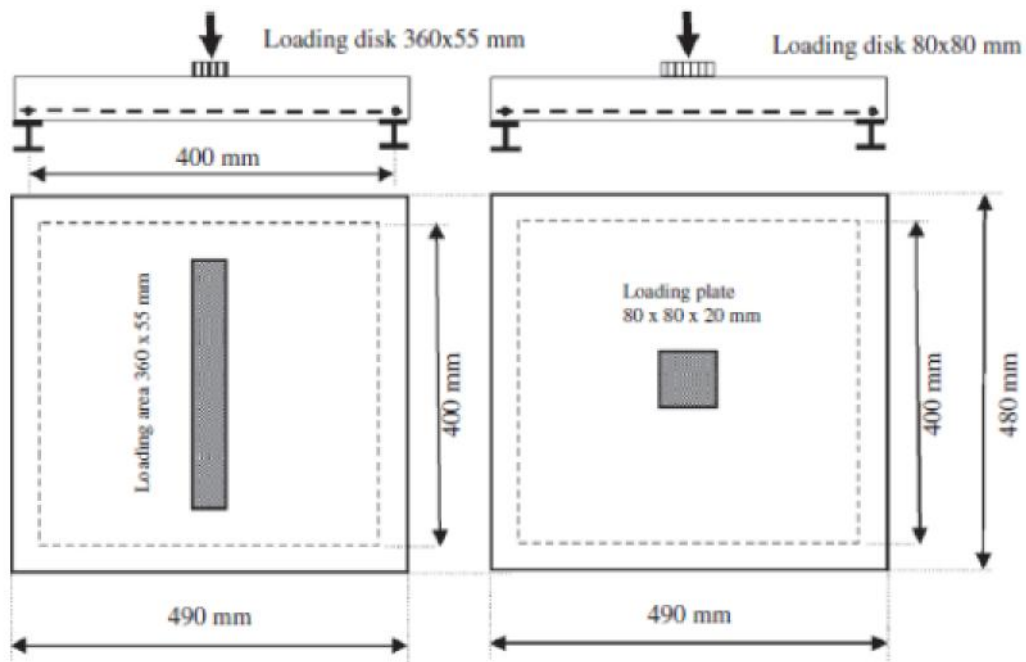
Mise en place pour l'essai de panneau de dalle
